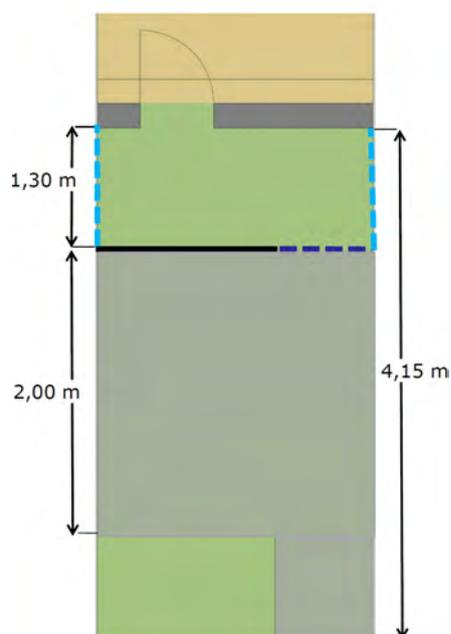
Grundrissvariante Abferkelbucht mit Mistgang
